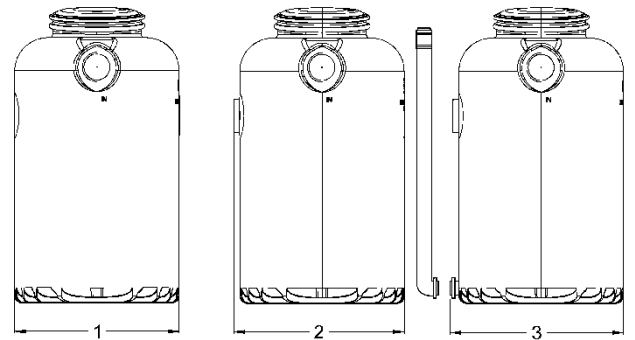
Basic (1) | Inspection (2) | Inspection & Drain (3)
